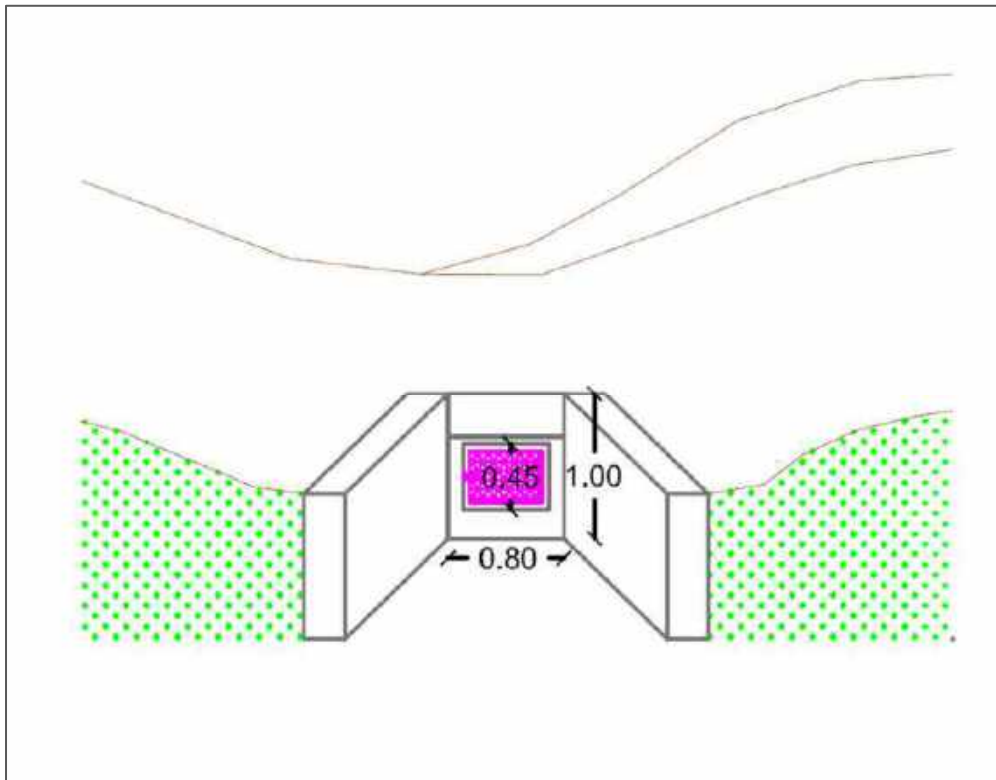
Pianta e Prospetto frontale Sorgente Cerretoli
